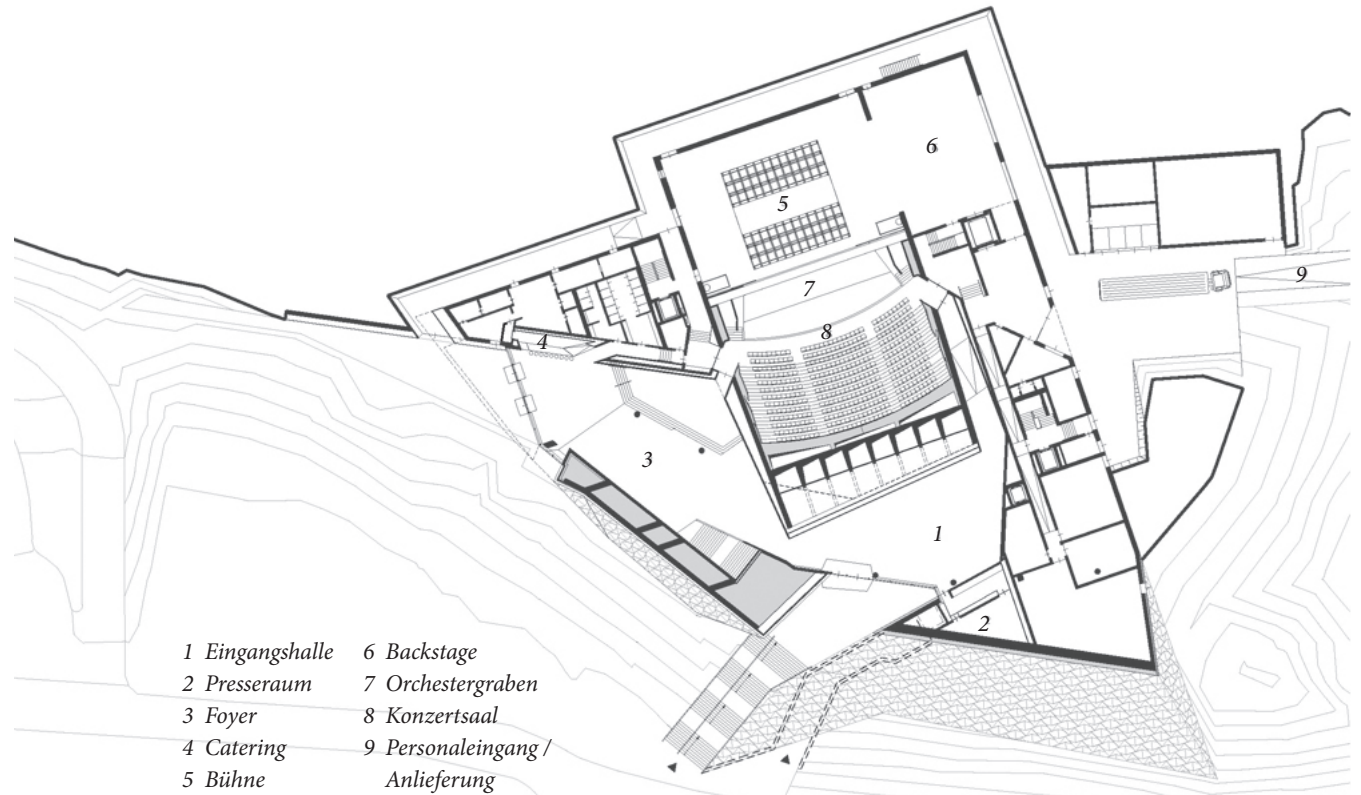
Festspielhaus Erl, Grundriss Erdgeschoß, o.M.
